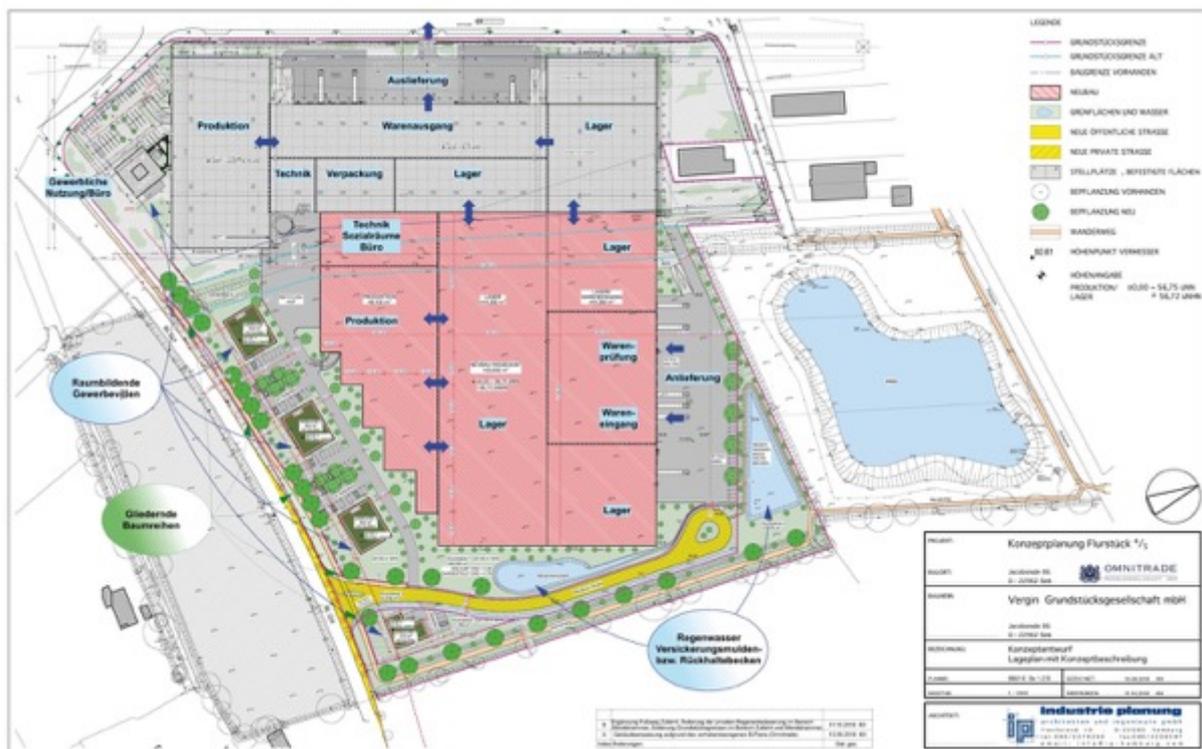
Planung mit Konzeptbeschreibung (M 1:1000 i.O., industrie planung, 10/ 2018)
